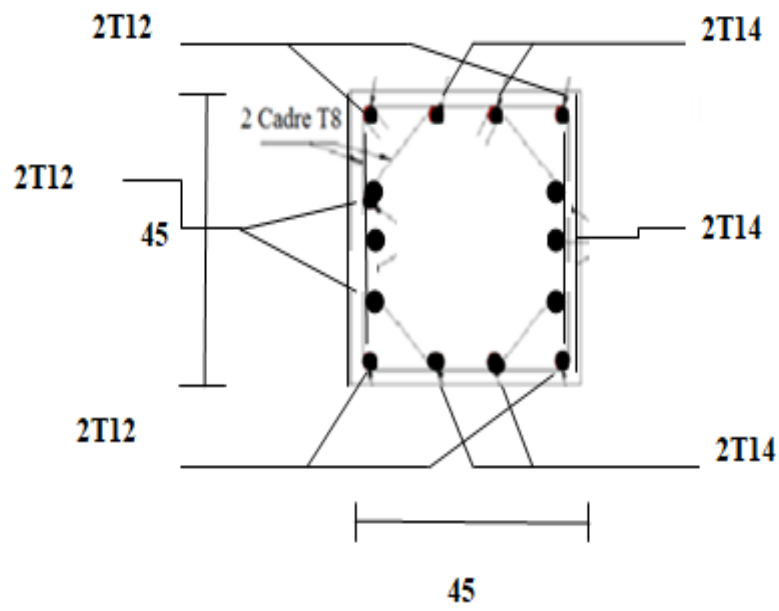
Ferrailage des poteaux (45x45) cm²
